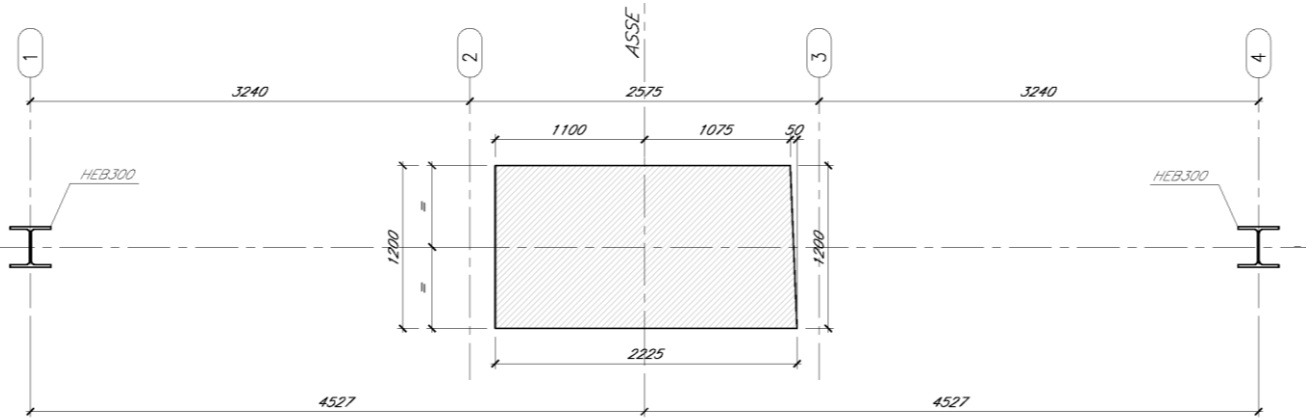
Sezione orizzontale pila 2 - Geometria [mm]
